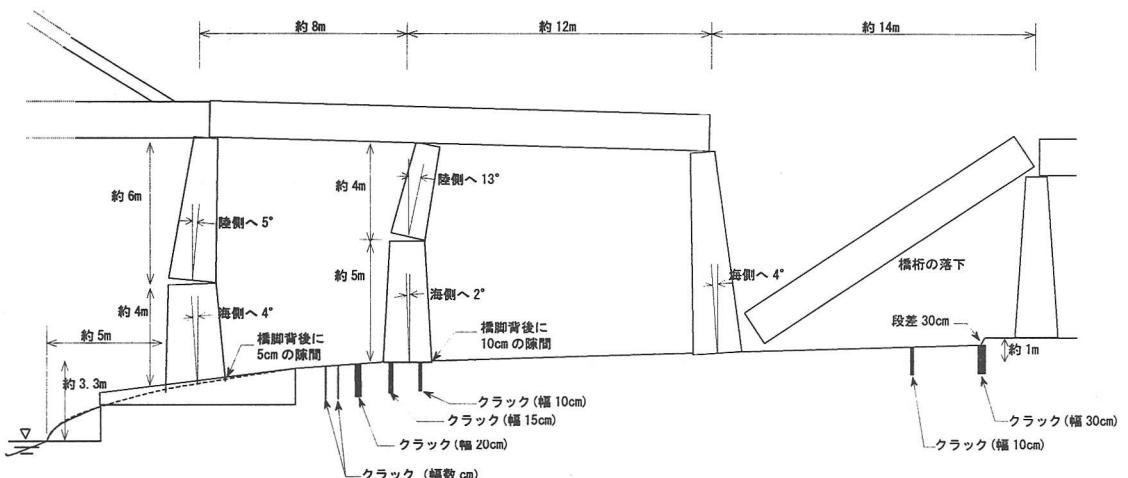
地盤の流動により被害を受けた鉄道橋の被害状況
